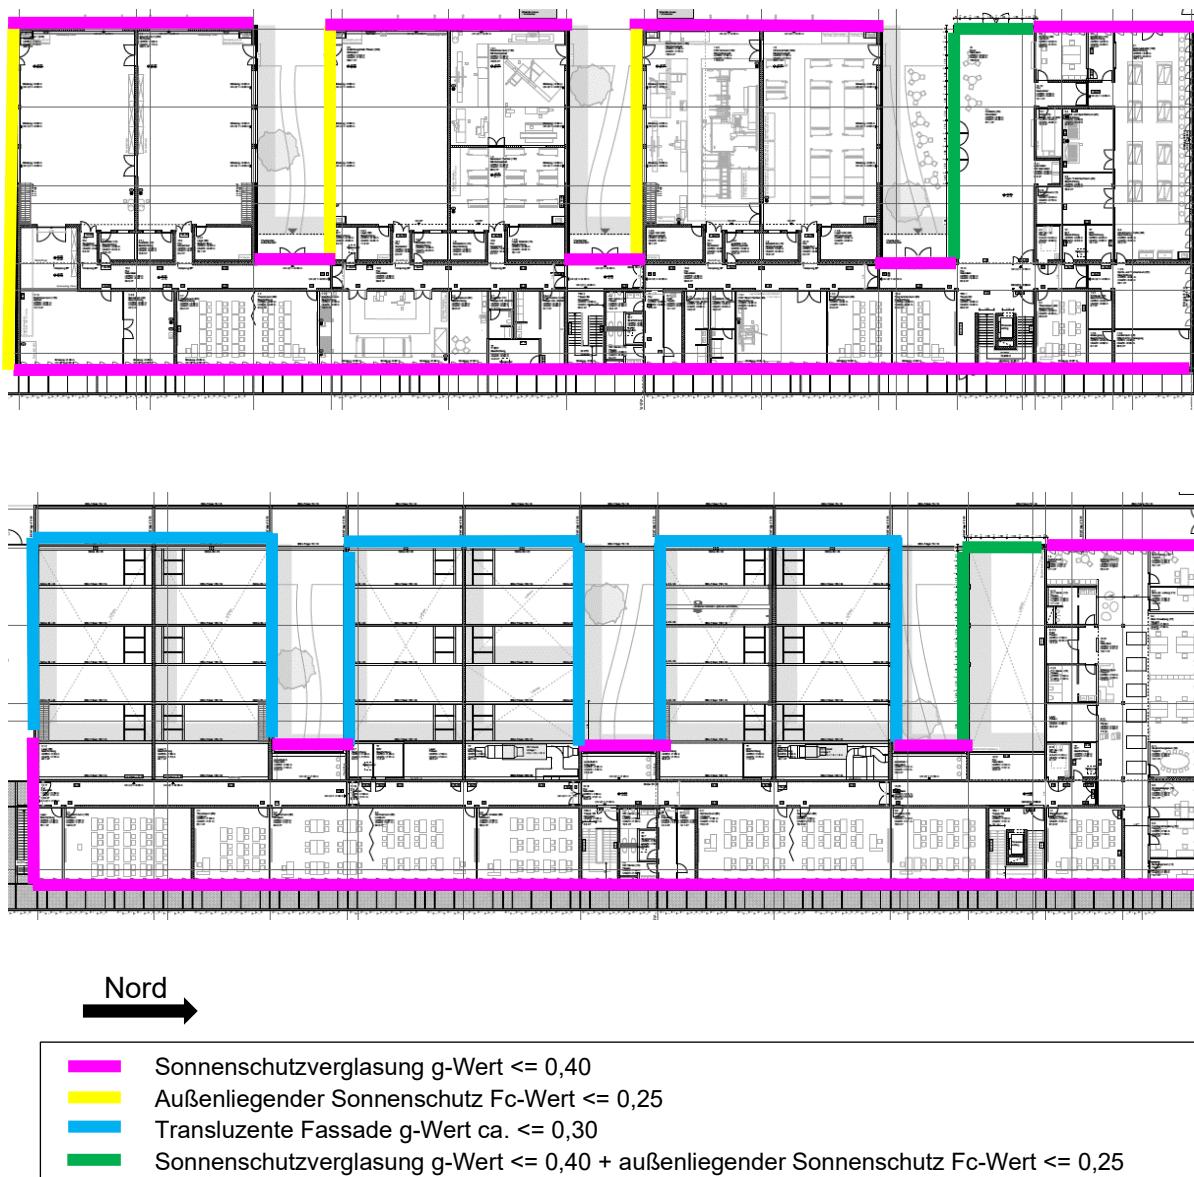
Sonnenschutzmaßnahmen Grundriss EG (oben) und Grundriss OG (unten)
